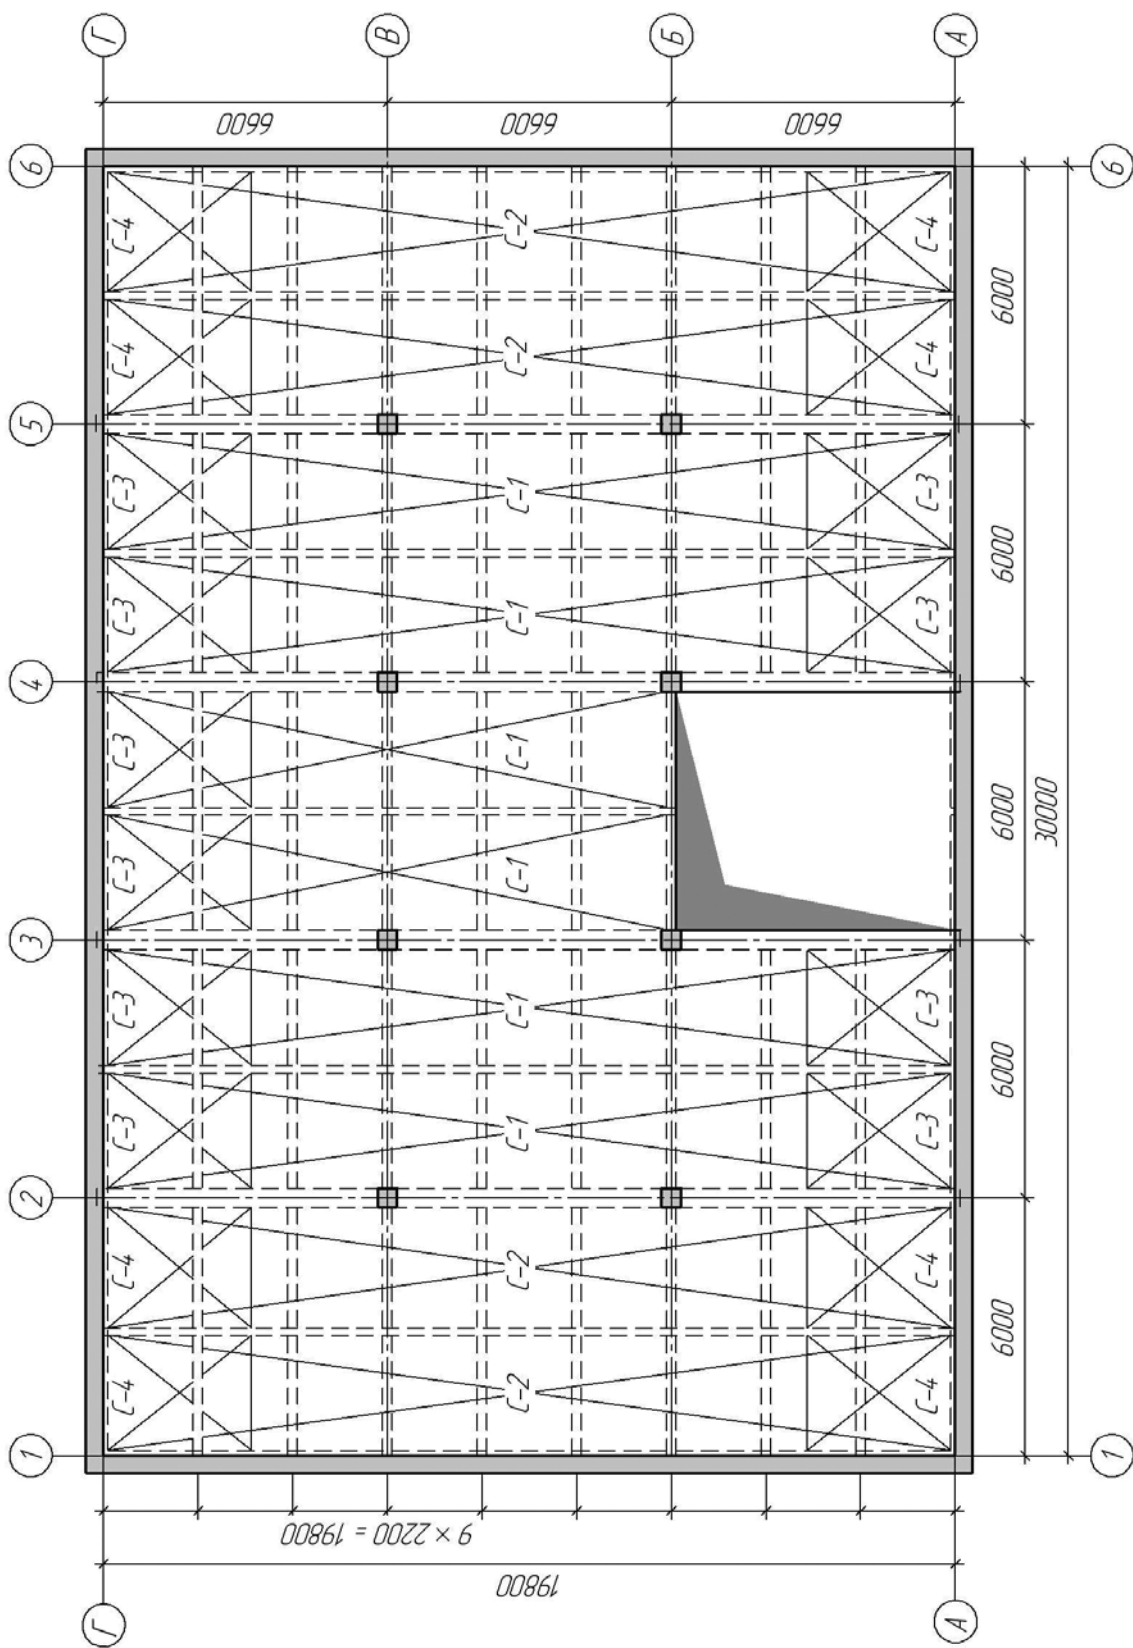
Непрерывное армирование балочной плиты рулонными сетками с продольной рабочей арматурой
